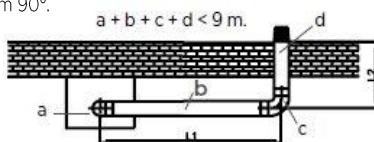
Montaż elementów zestawu przewodów spalinowych
